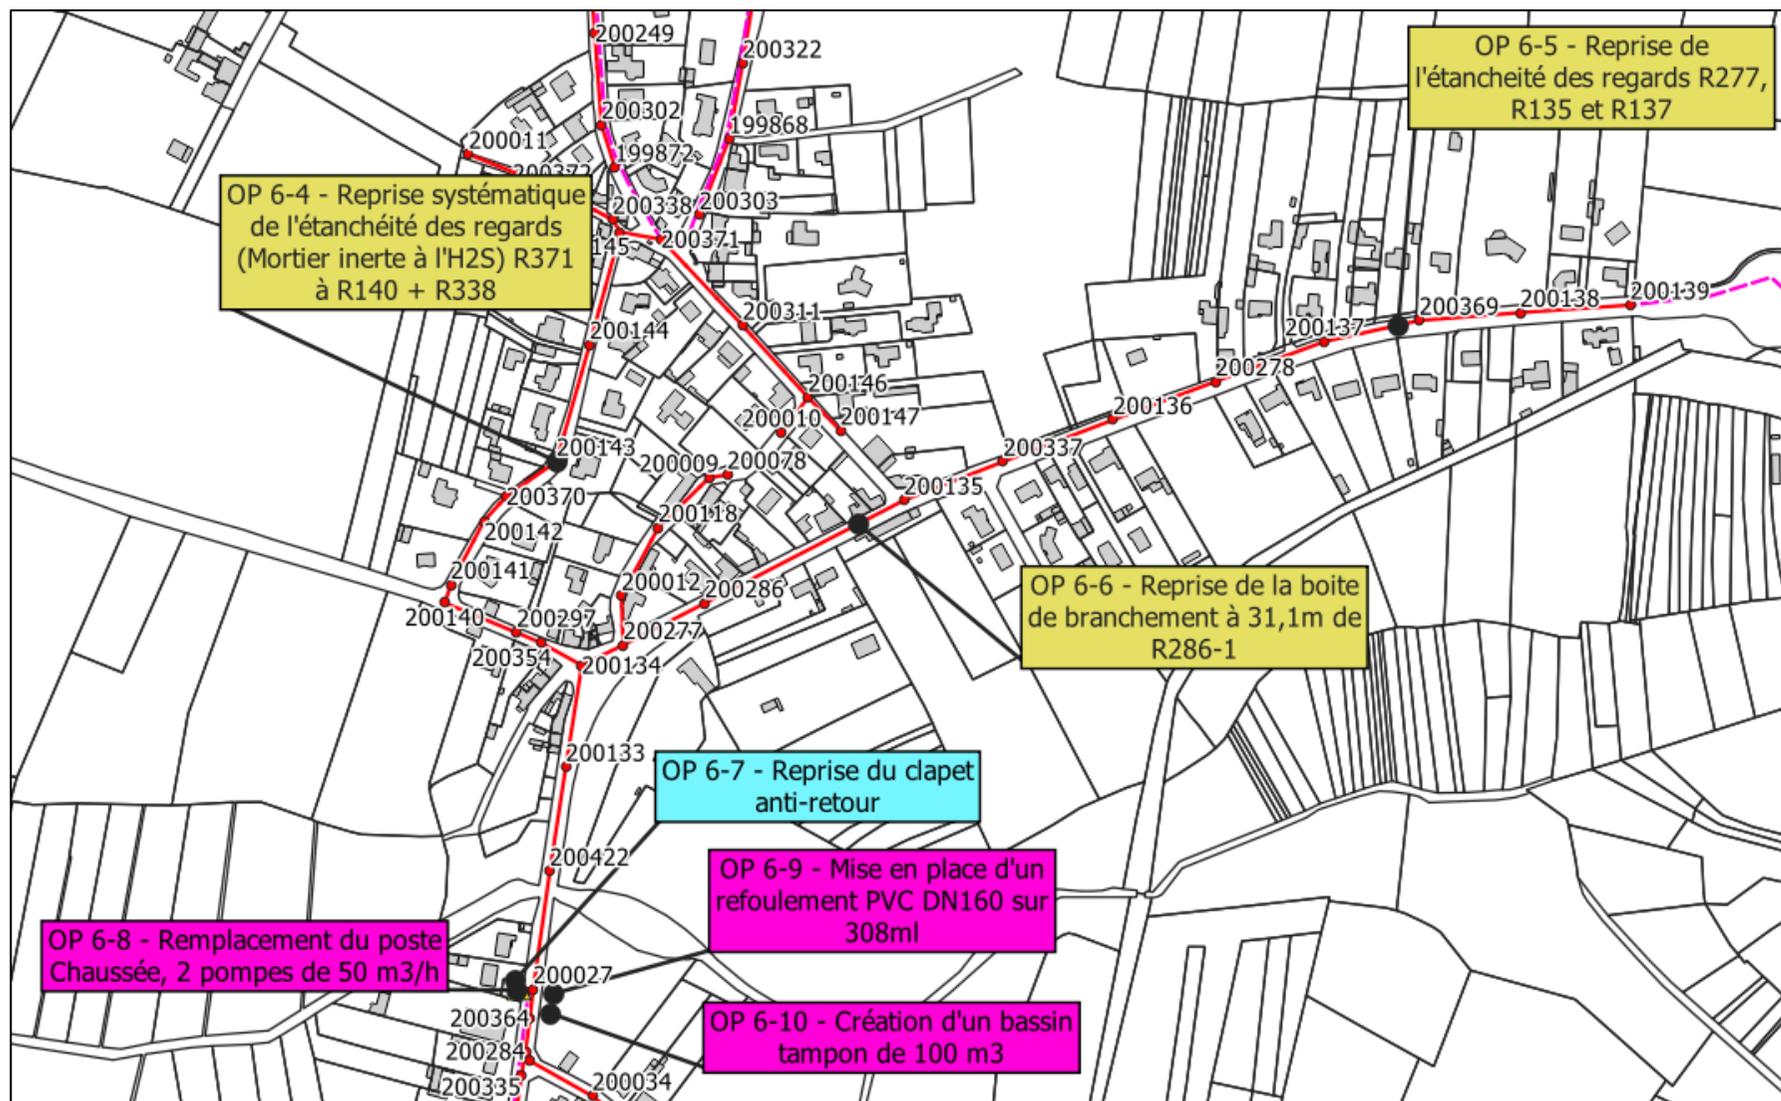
Plans de travaux préconisés - secteur Chaussée
